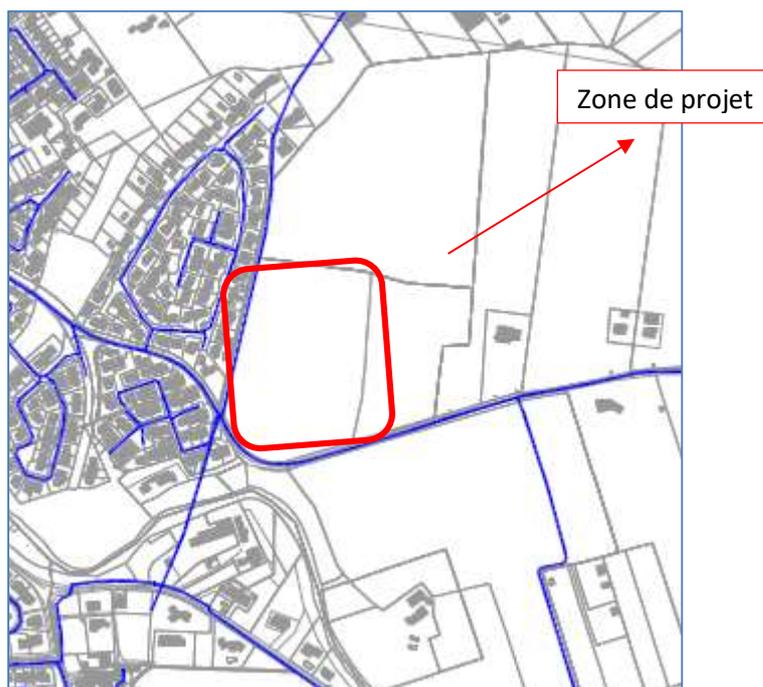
Extrait du plan du réseau AEP, PLU La Crau, annexe 8.B.2
